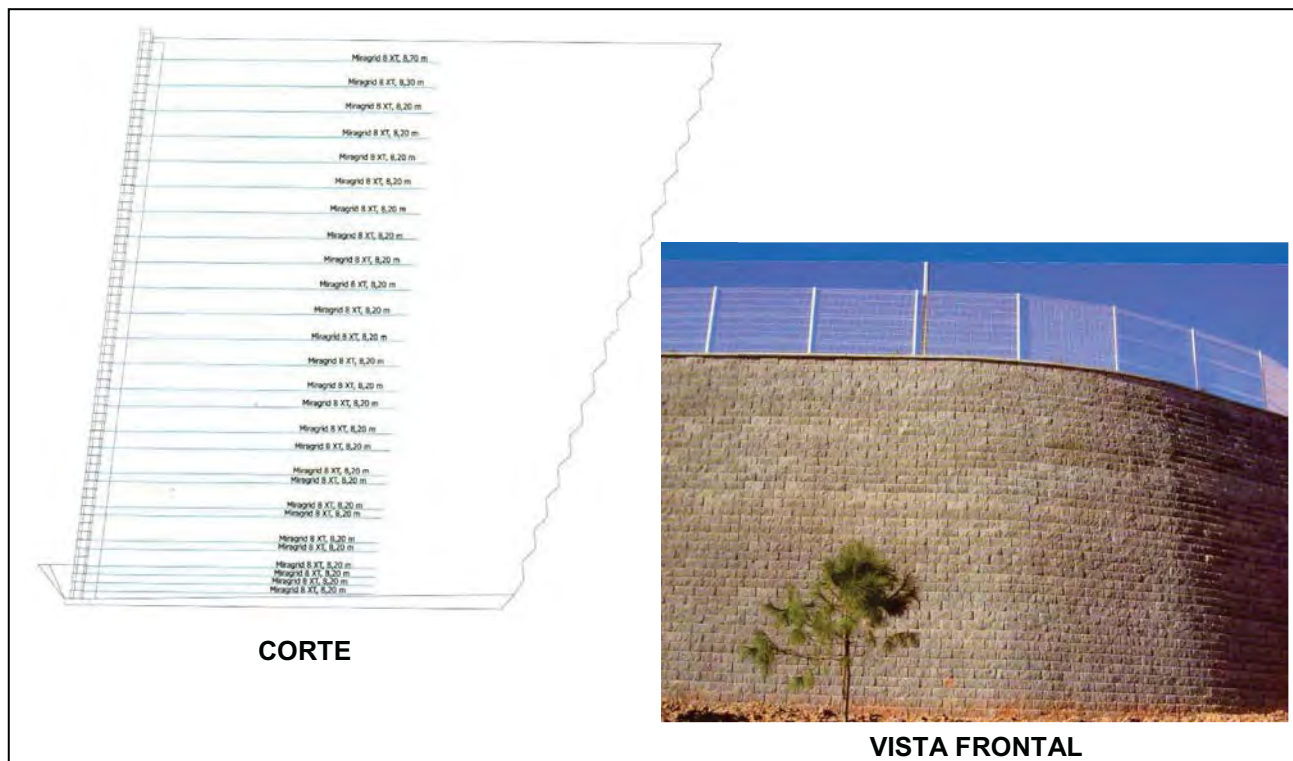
MUROS DE CONTENCIÓN CON TIERRA ARMADA CON GEORED PLÁSTICA Y PIEZAS DE BLOCK MONTADAS EN SECO (sin mortero) DE HASTA 14.00m DE ALTURA
